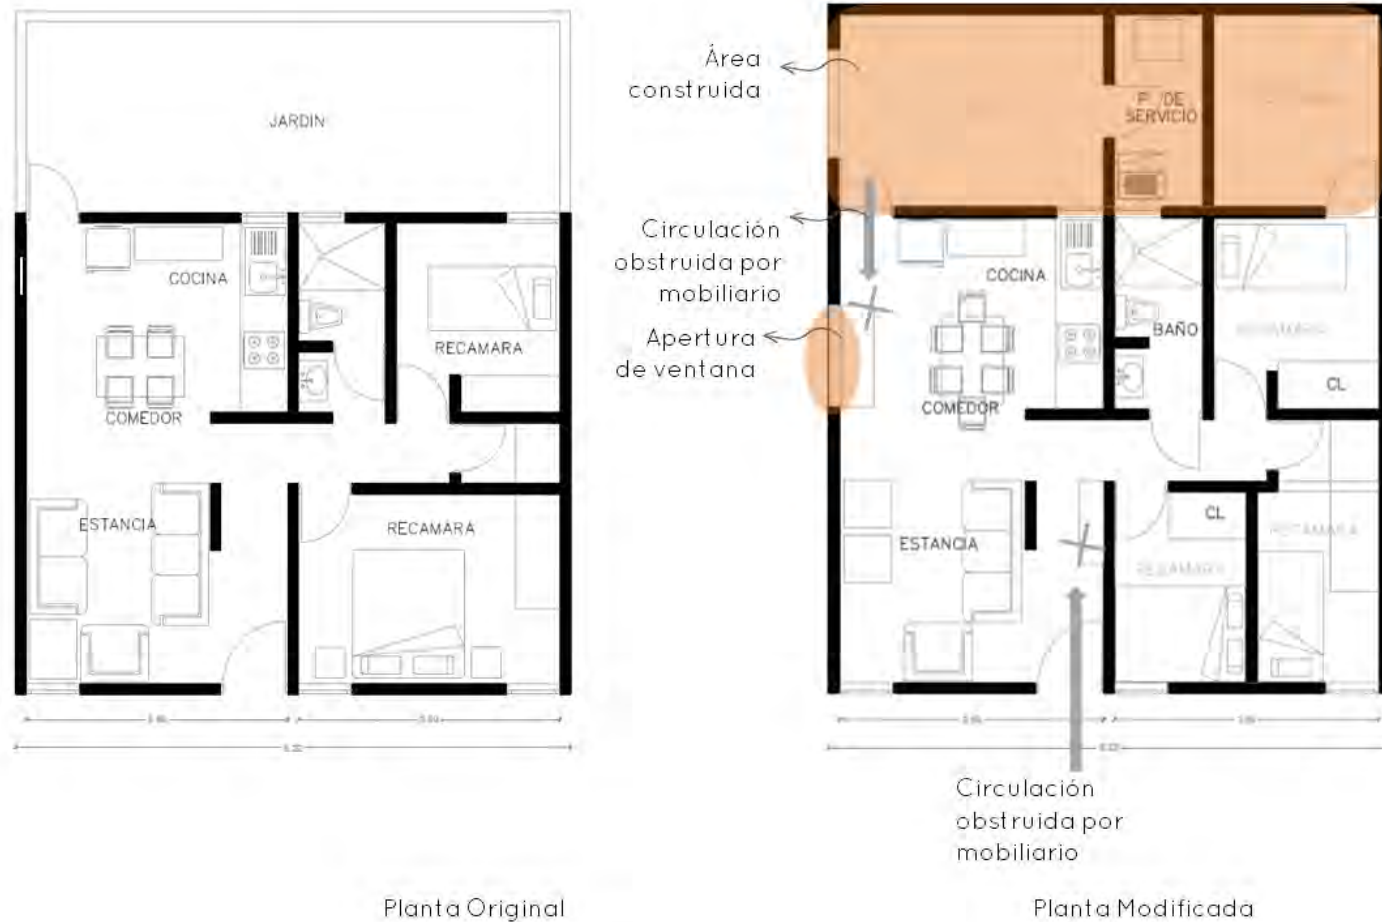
Planta actual comparada con la original, indicando los elementos que afectan y modifican al espacio.
